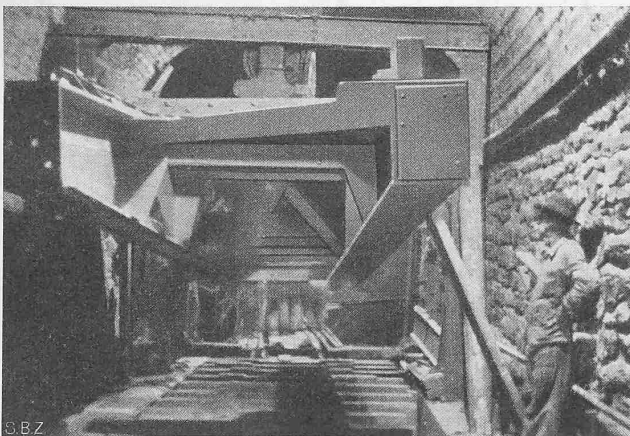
Einbau des Kragträgerpaares im Tunnel am umlegbaren Abnahmebock (in Abb. 37 «Montage-Portalkran»)
